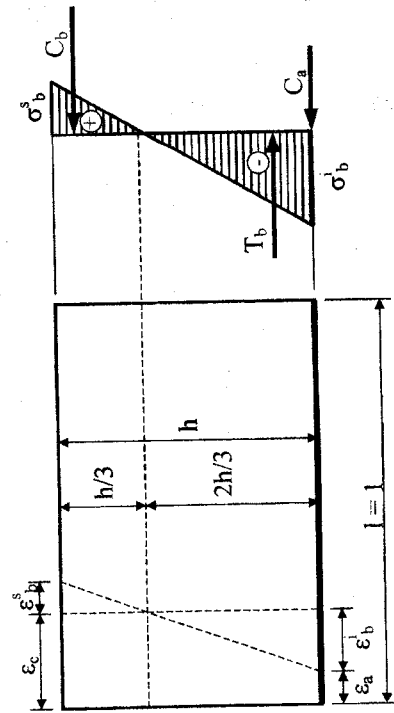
Contractia betonului în elementele armate nesimetric
